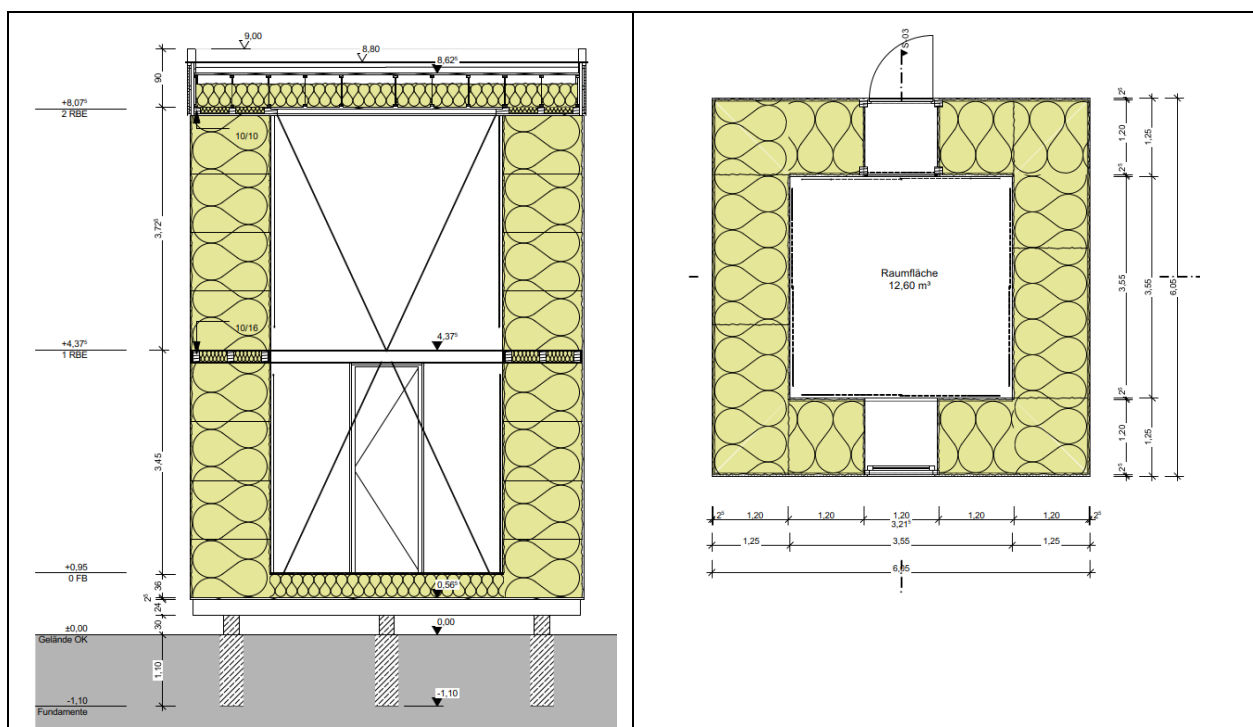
Planungszeichnungen Forschungsdemonstrator Strohturm: Längsschnitt (links) und Grundriss (rechts), Quelle: Z-Architektur
